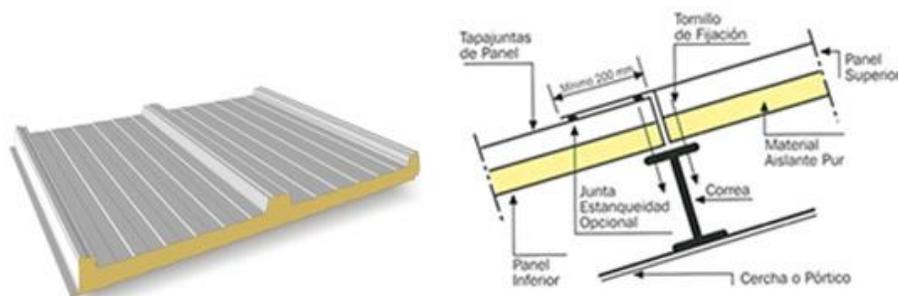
cubierta tipo sándwich más corte de cubierta.
